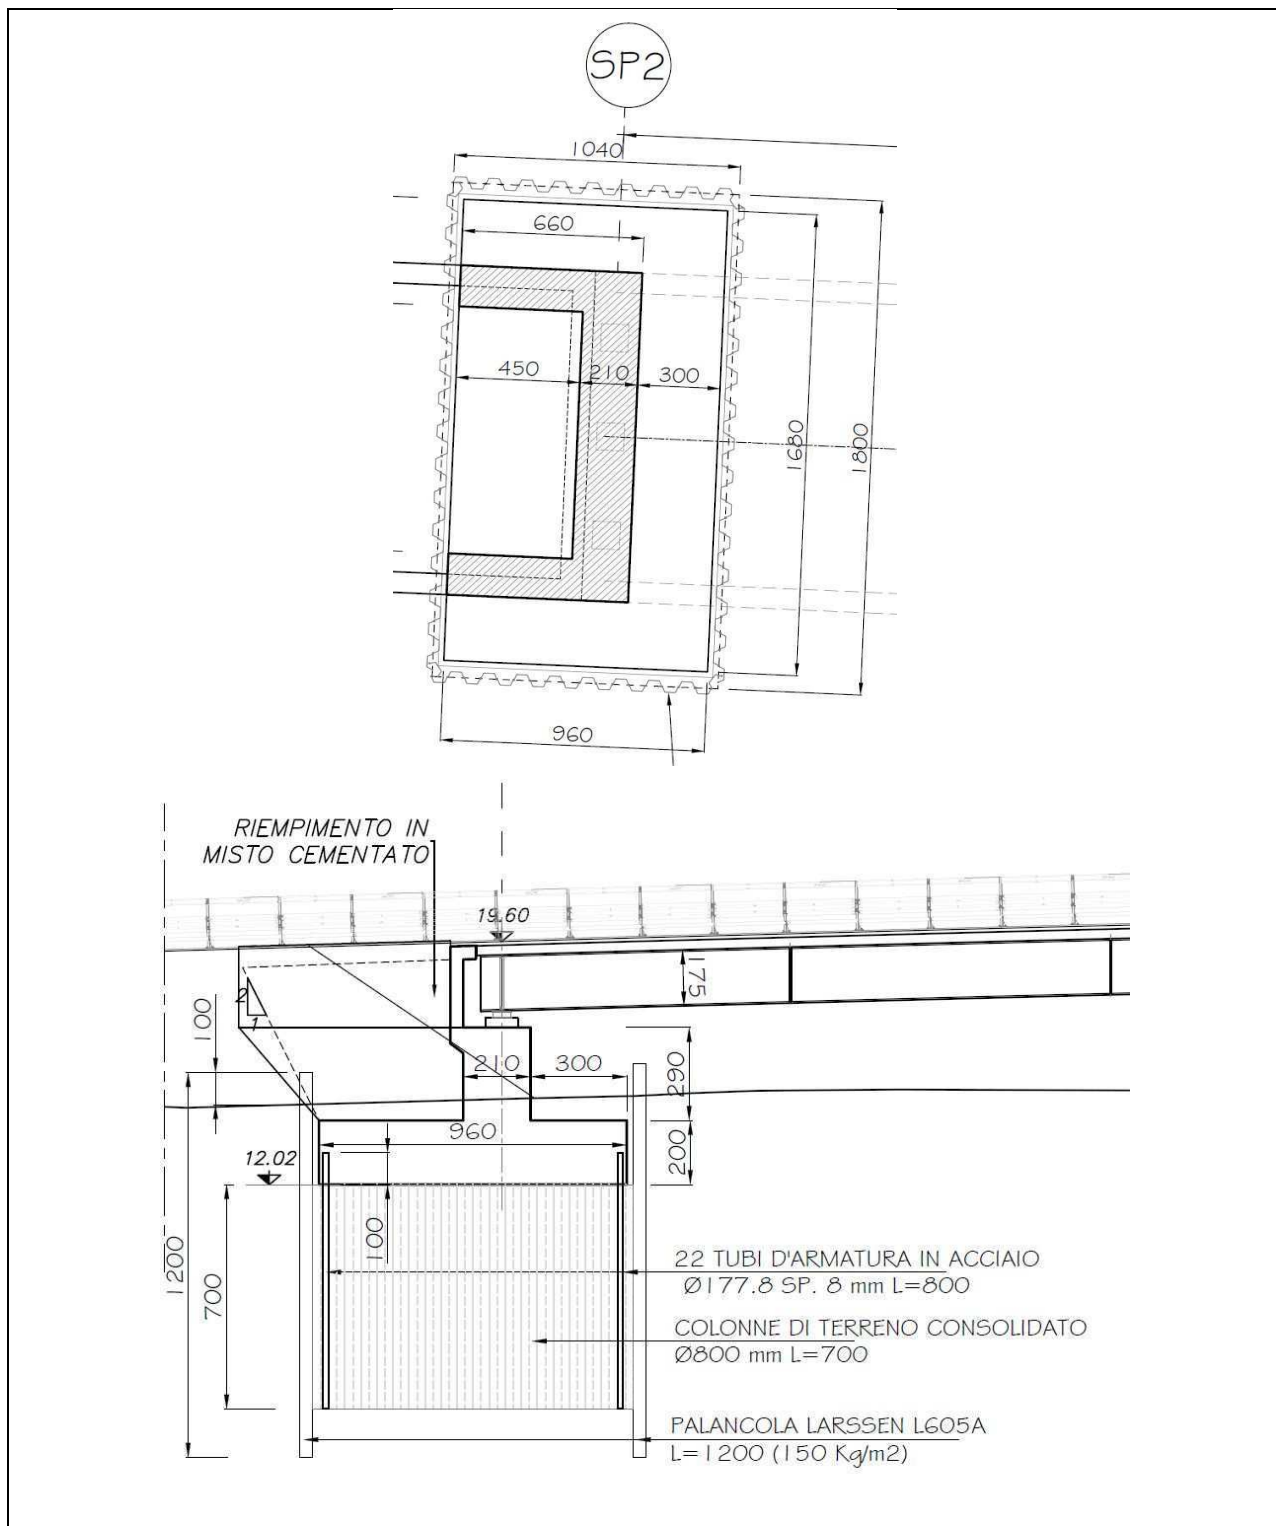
Spalle - Pianta Fondazioni Sezione Fondazioni
